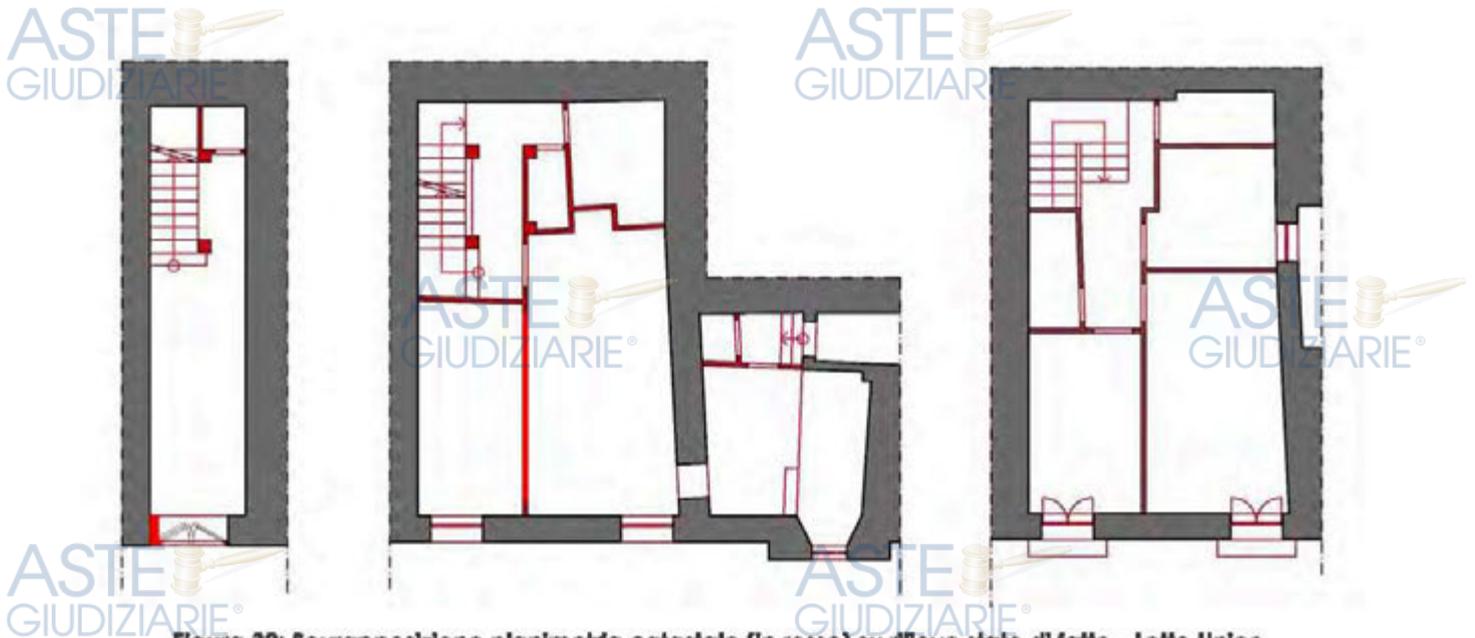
Sovrapposizione planimetria catastale (In rosso) su rilievo stato di fatto - Lotto Unico
